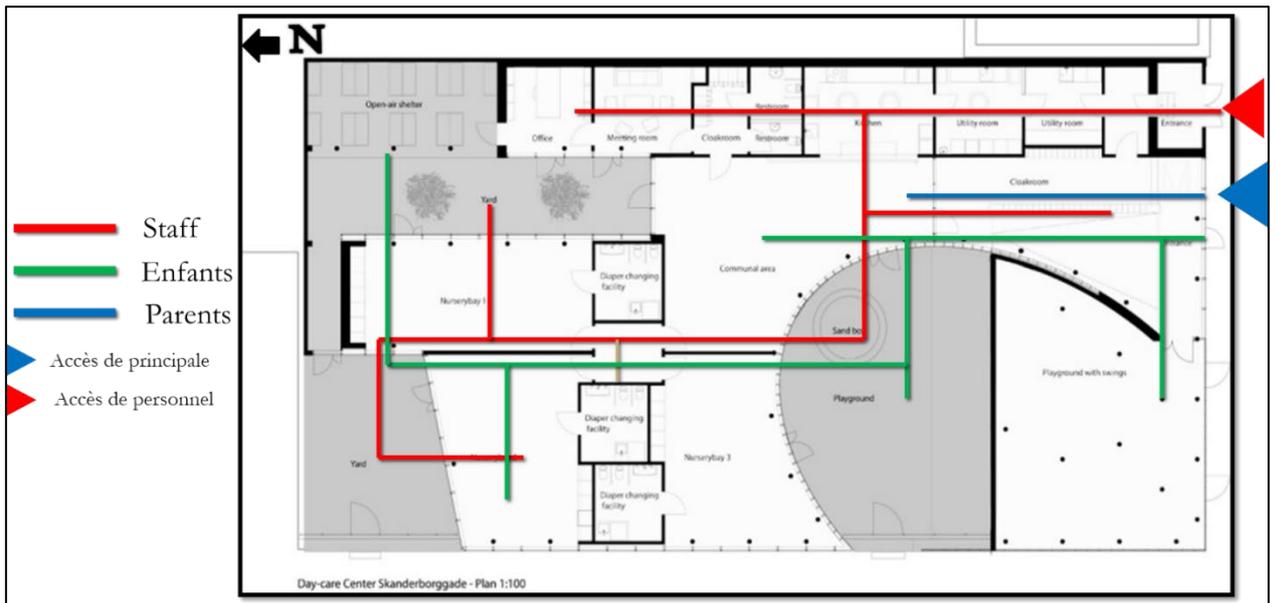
Plan de rez de chaussée, Copenhagen day-care center.
